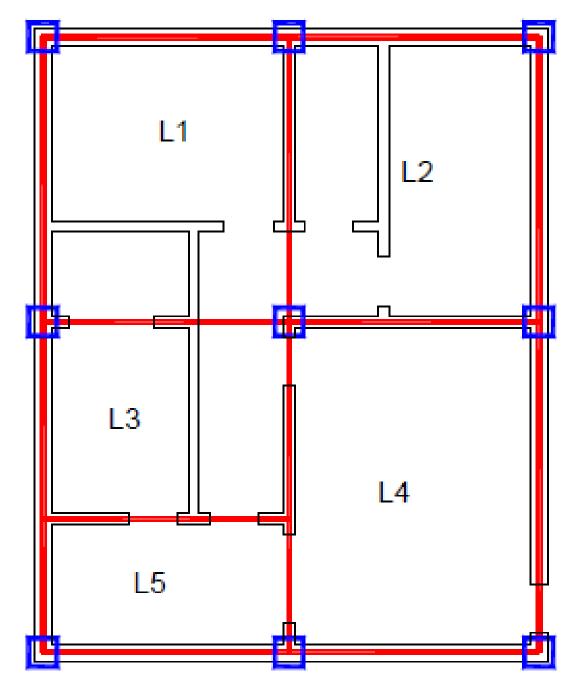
Posicionamento final de vigas, lajes e pilares [9].
